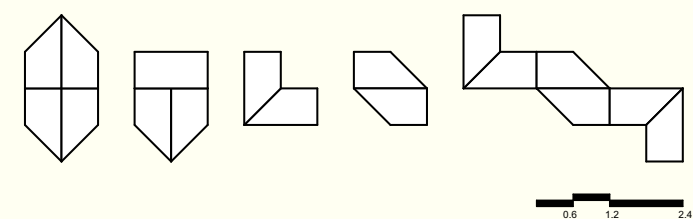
Planta baixa com proposta de organização espacial para as áreas de exposições
